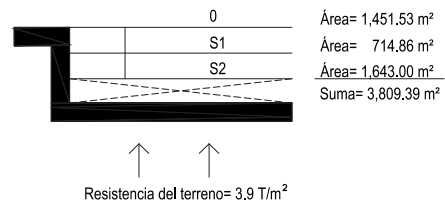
| Losas de sótano para cálculo de cimentación
